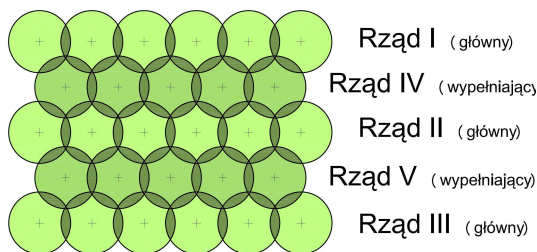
Sposób formowania cementogruntu w wariantcie D jet-grouting
